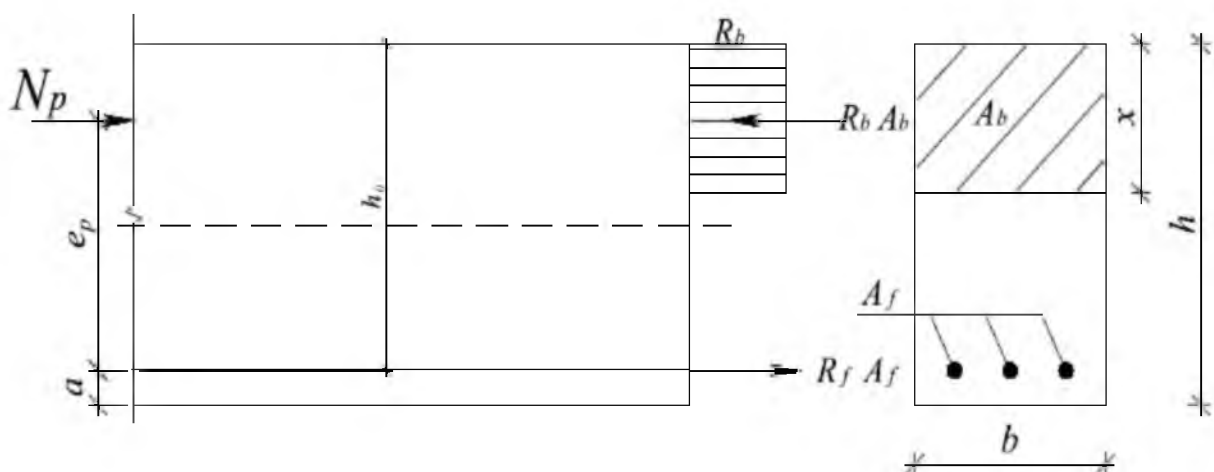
Схема усилий и эпюра напряжений в сечении, нормальном к продольной оси изгибаемой предварительно напряженной конструкции при ее расчете по прочности в стадии обжатия
